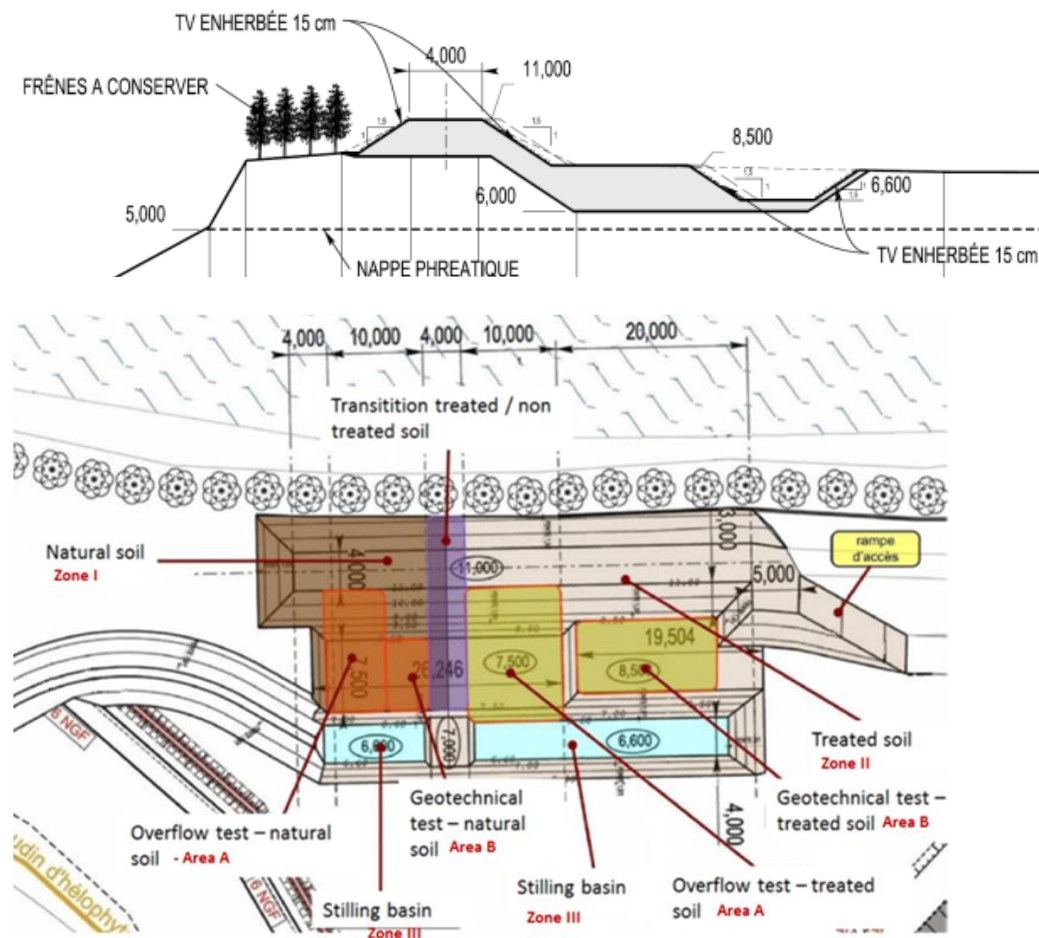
Coupe de la digue expérimentale (haut) et implantation (bas) – plan ISL
